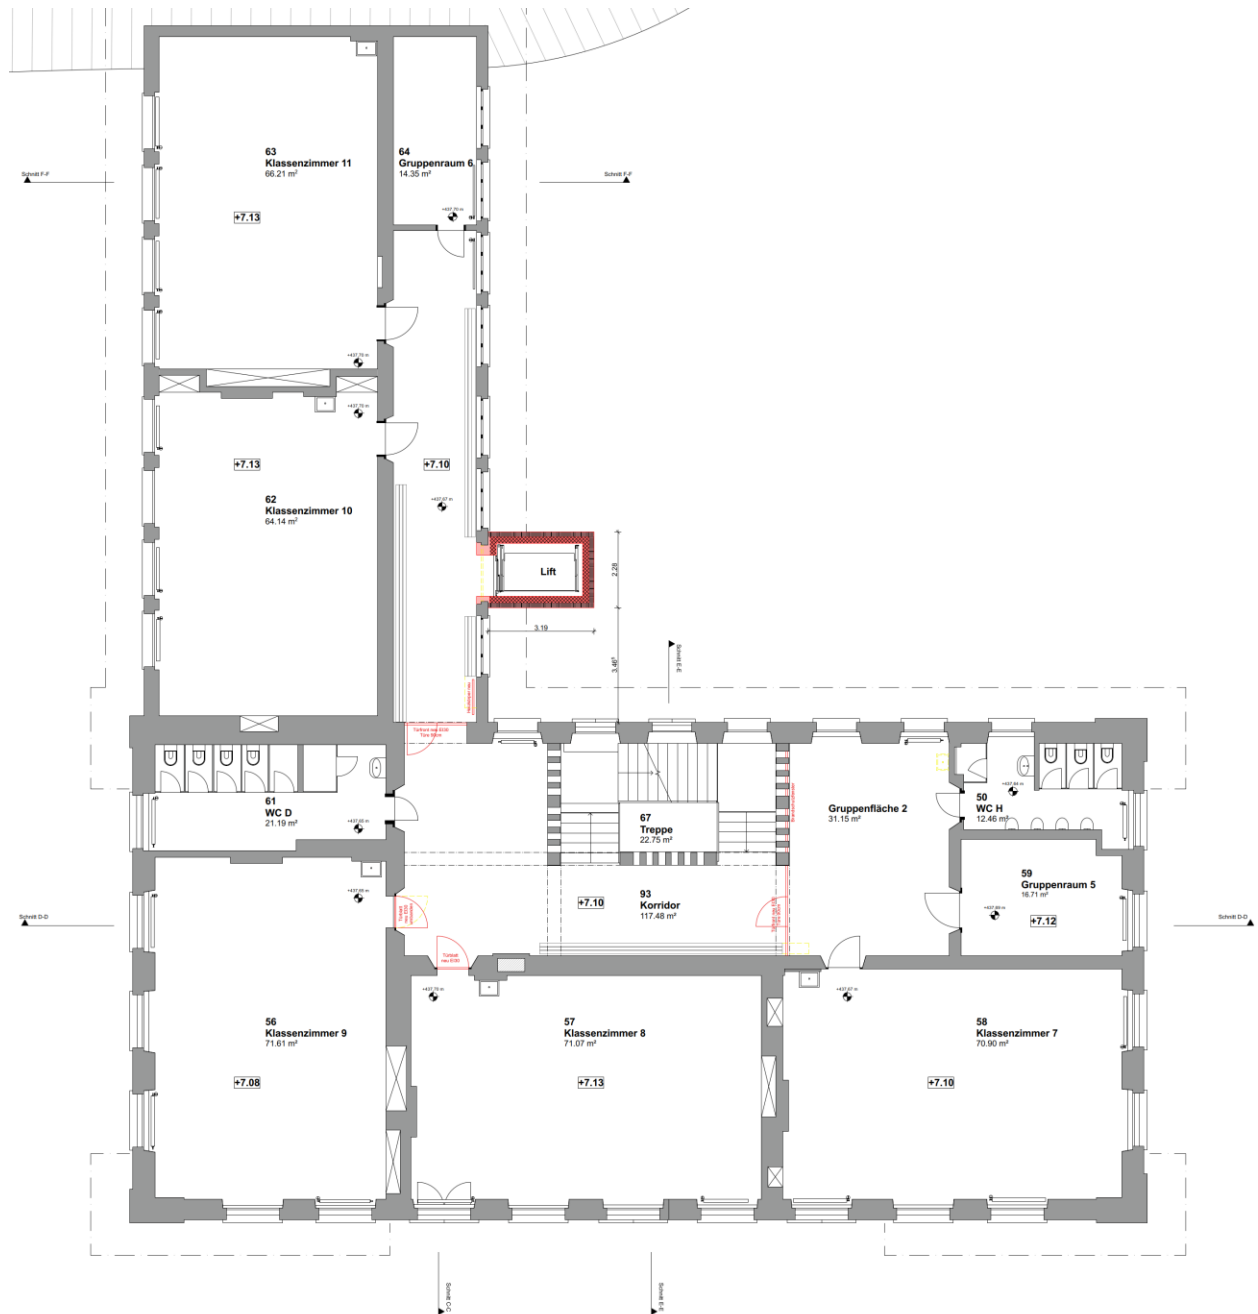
Grundrissplan 2. Obergeschoss
